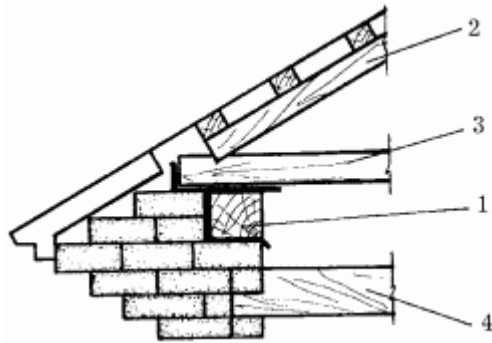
Опираение наслонных стропил в каменных зданиях: 1 – мауэрлат; 2 – стропильная нога; 3 – затяжка; 4 – чердачное перекрытие.
